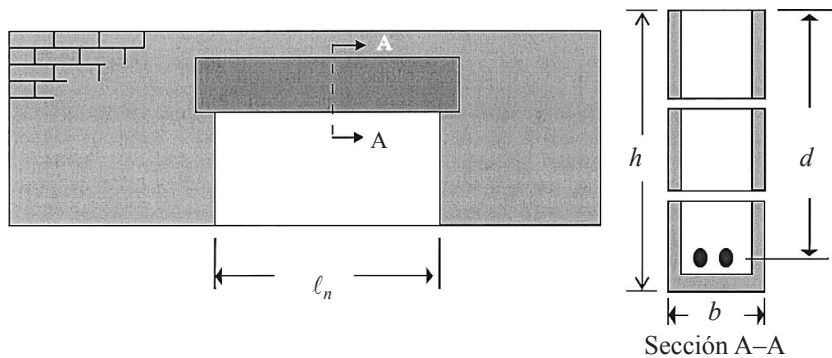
Elevación y sección transversal de un dintel de mampostería
